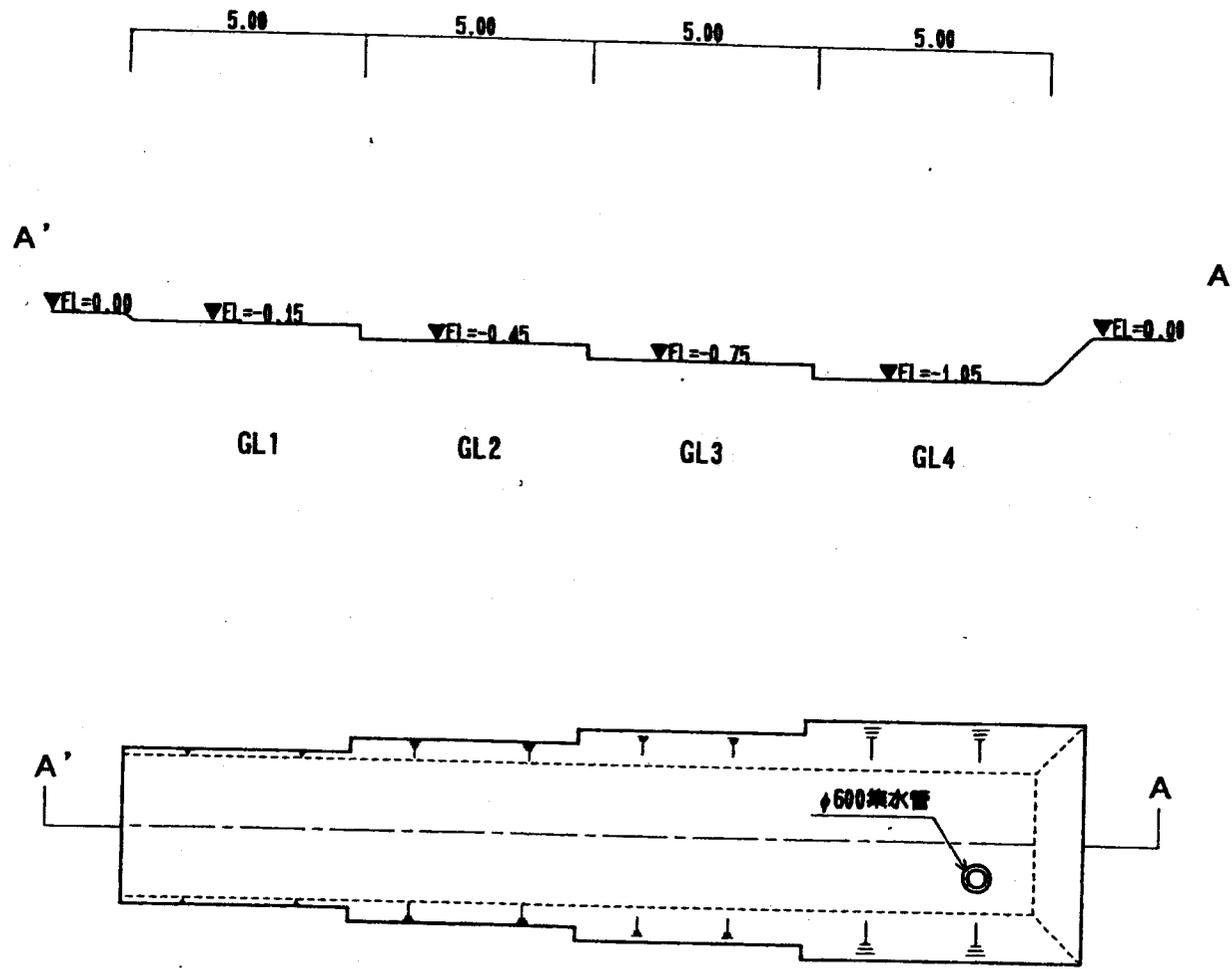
1 9 实验池 (No.2) 平面图及乙断面图
